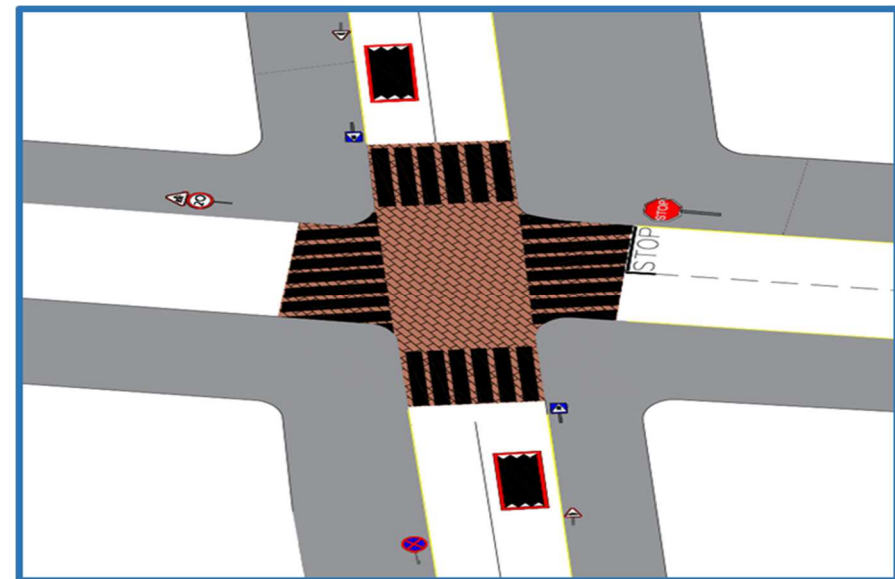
Cambio de textura en la pavimentación de la 2º intersección
